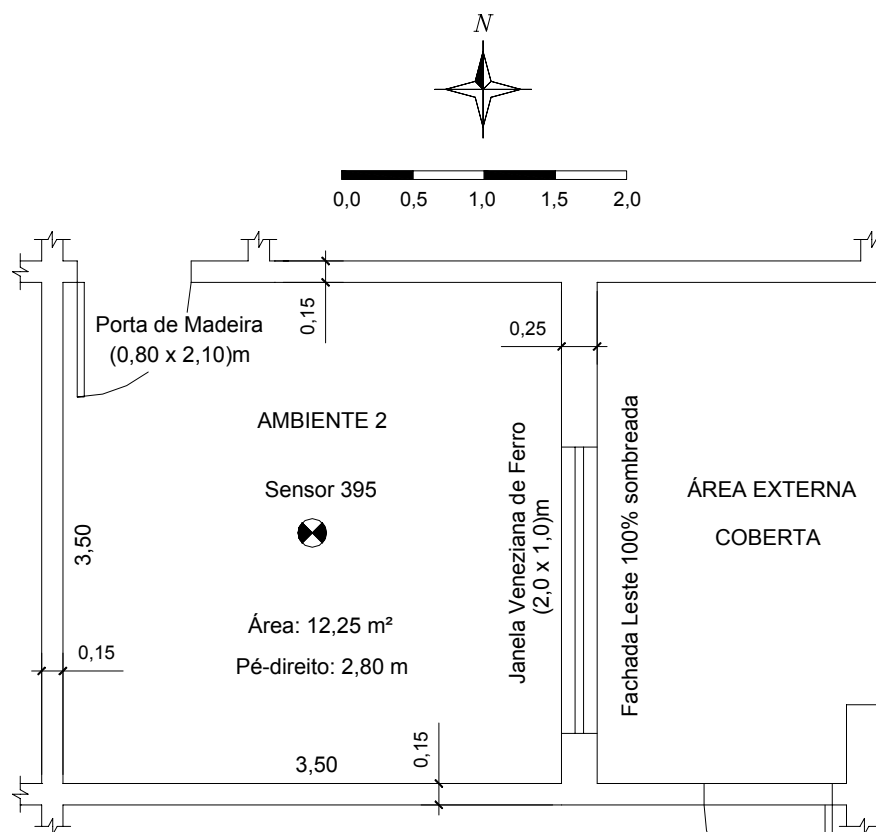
Planta baixa do ambiente monitorado - Edificação 2.
